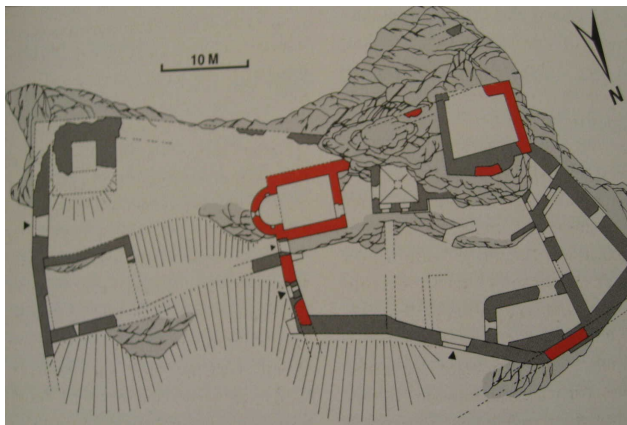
Grundriss Ruine Eibenstein
